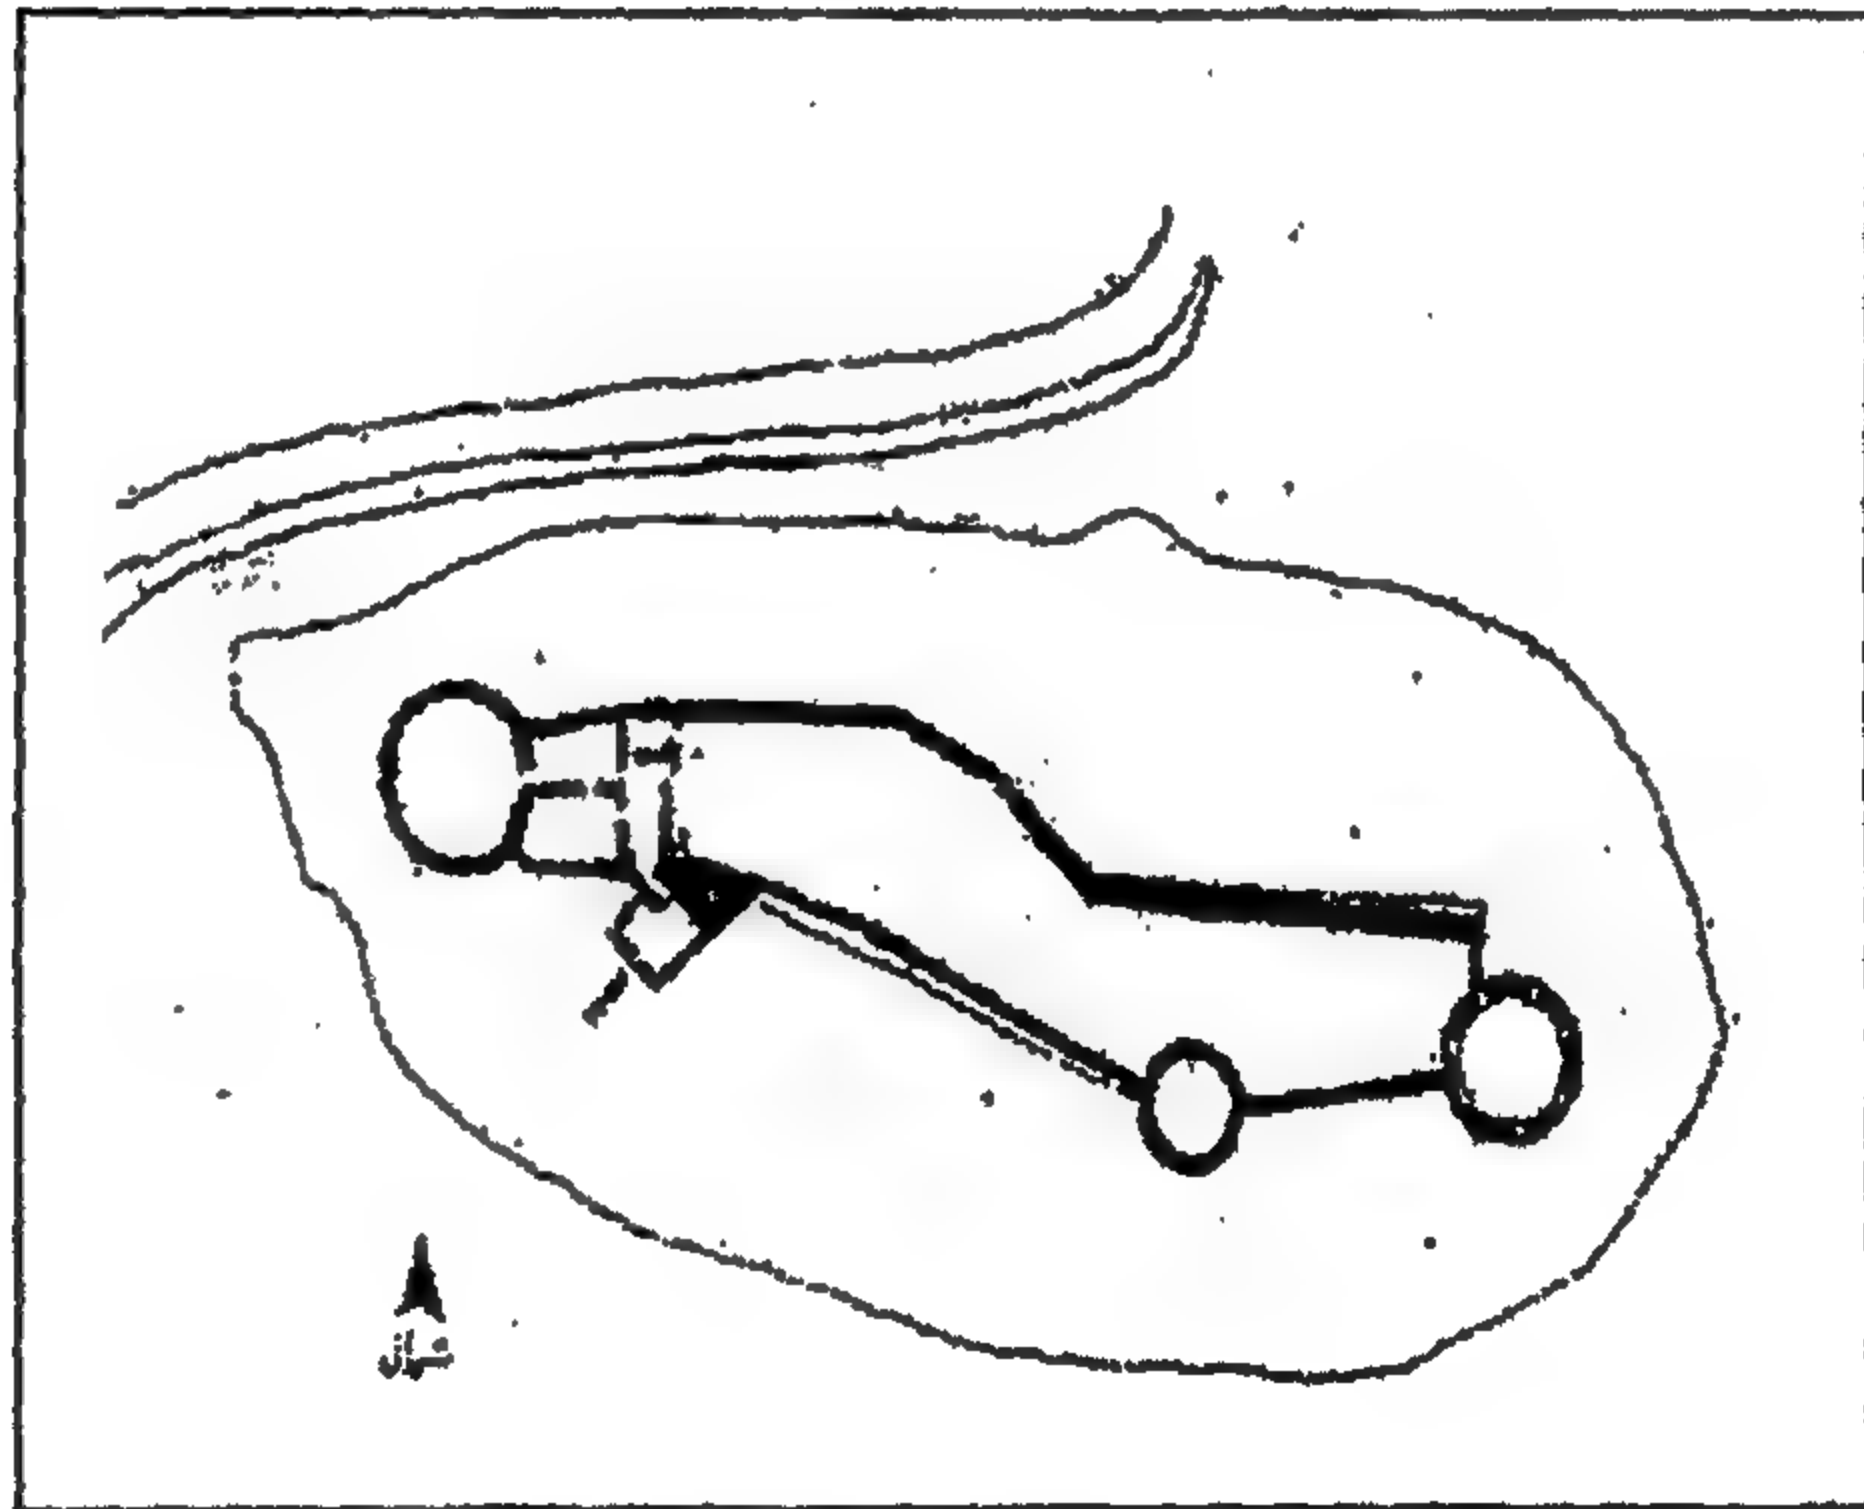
مسقط أفقي للدور الأرضي لقلعة المصمك عن:
